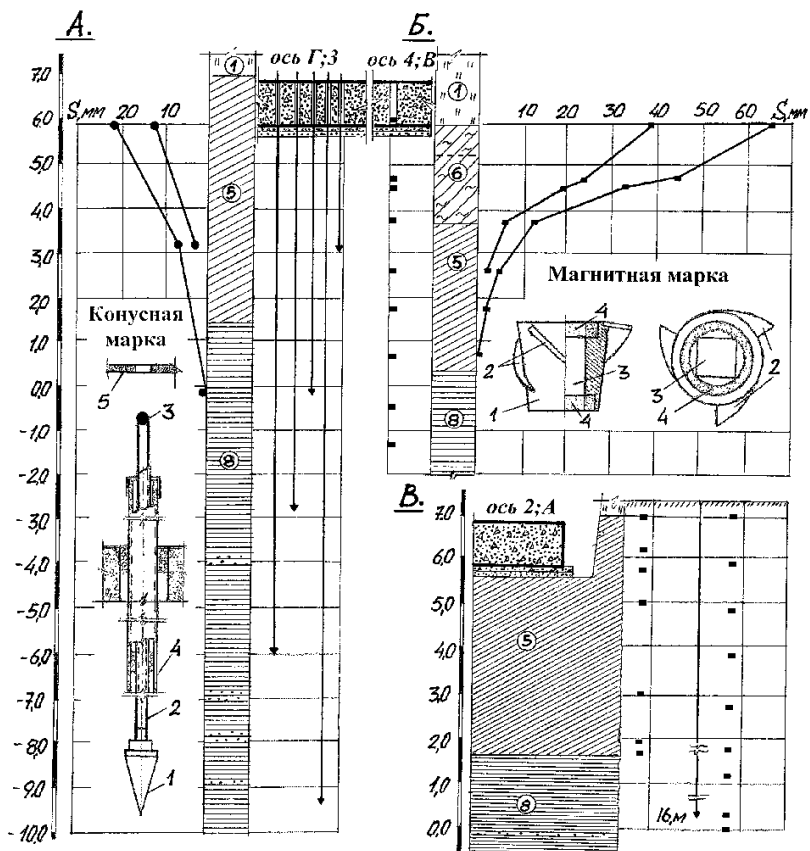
Развитие деформаций в грунтах основания фундаментной плиты здания:
